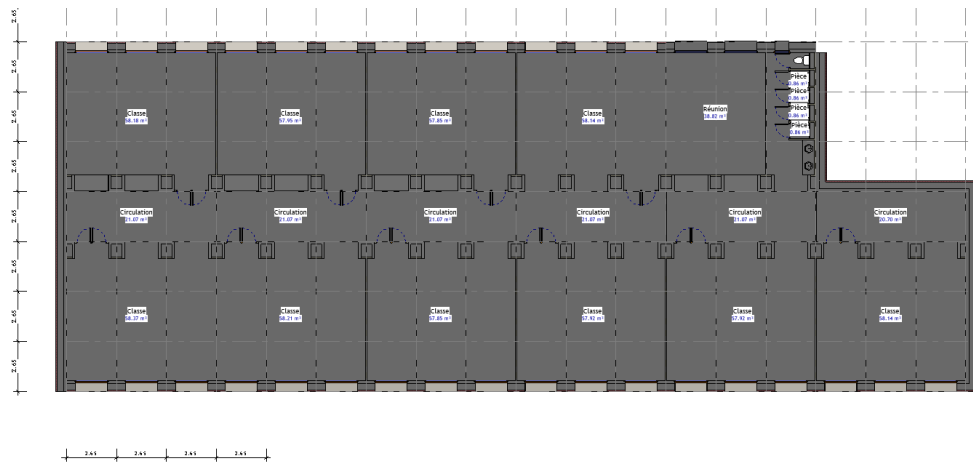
Exemple d'ajout des éléments spécifiques (dans cet exemple : cloisons, murs pignon, poteaux entre deux modules) par le chercheur dans Revit.
